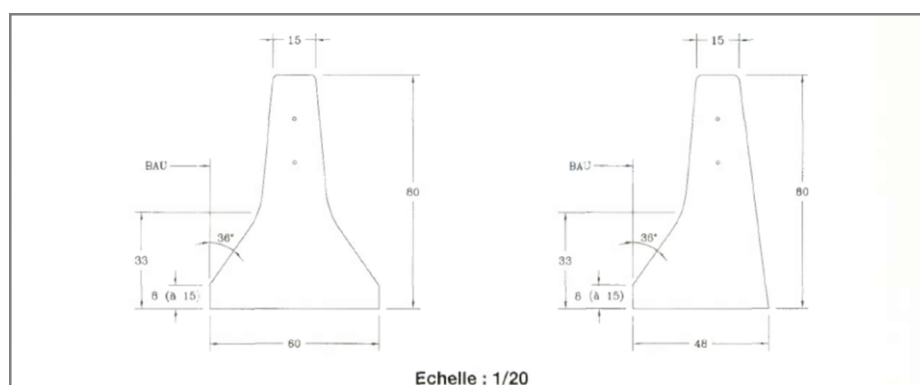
Secção transversal das barreiras do tipo DBA e GBA, adaptado do SETRA [10]
